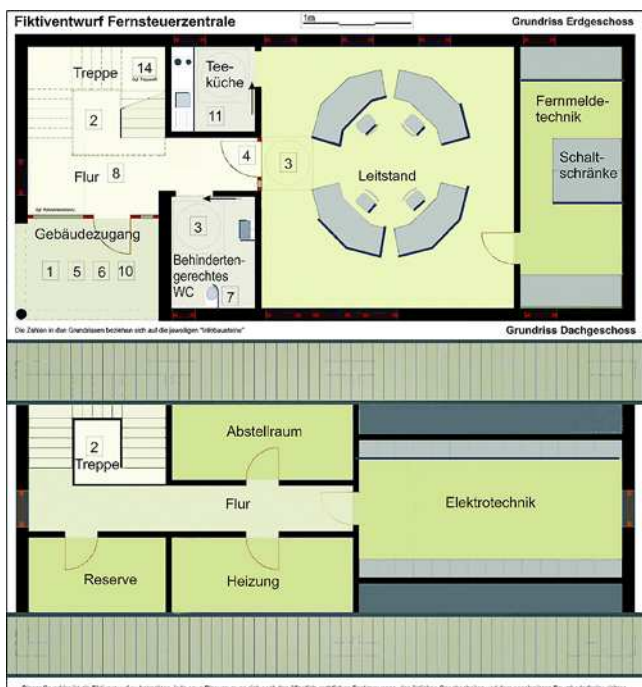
Erd- und Obergeschoss-Grundriss für den Fiktiv-Entwurf „Fernsteuerzentrale“
